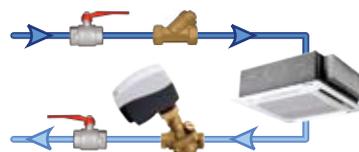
Вариант 3: без перерасхода (рекомендовано)
